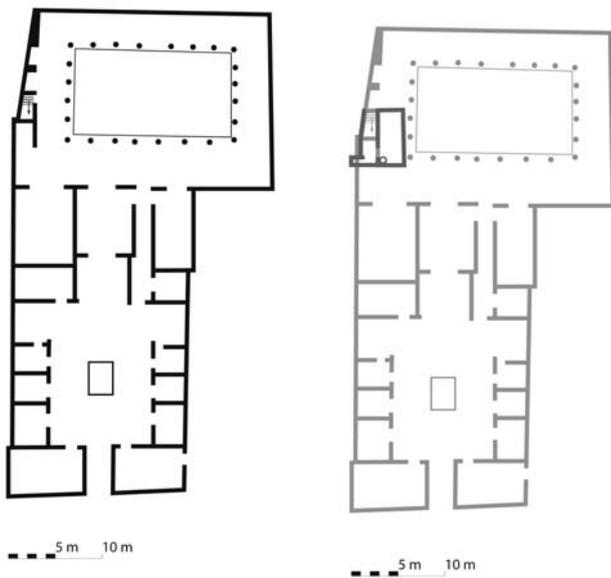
Grundriss Erdgeschoss und Keller (dunkelgrau im Peristylbereich) in der 1. Bauphase
